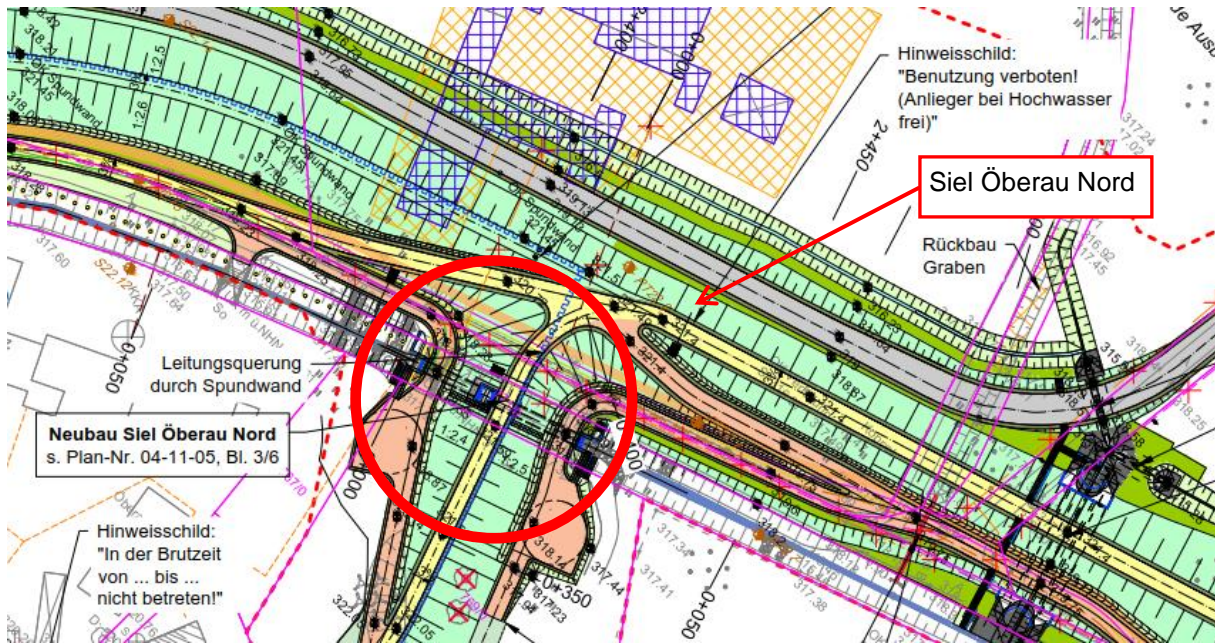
Siel Öberau Nord, Lageplan (aus Plan 03-03-03, Blatt 2/3)
